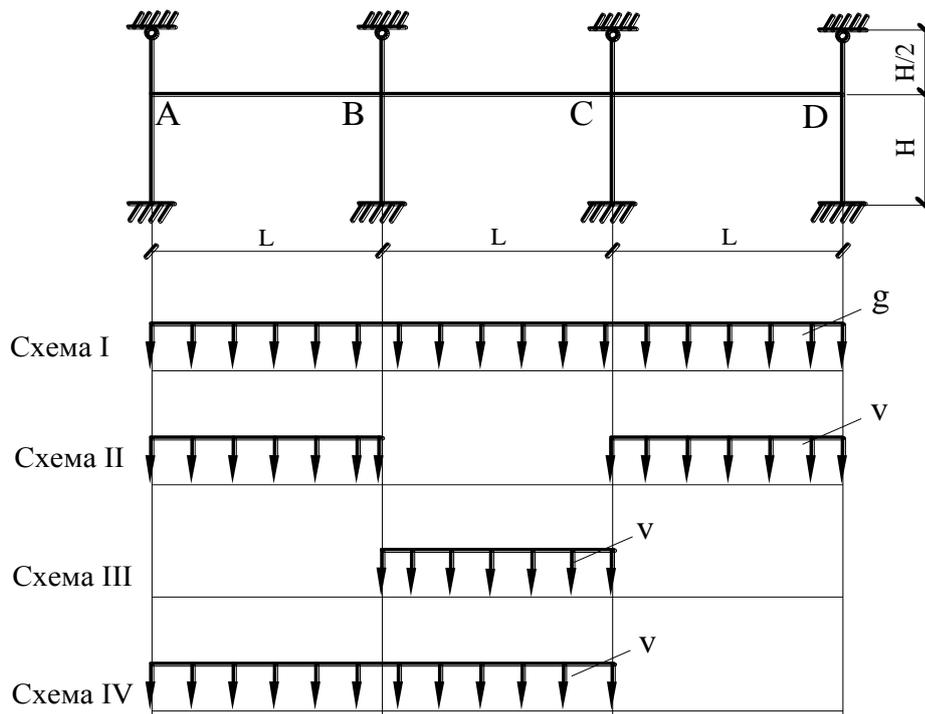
Схема рамы 1 этажа при расчете на вертикальную нагрузку
